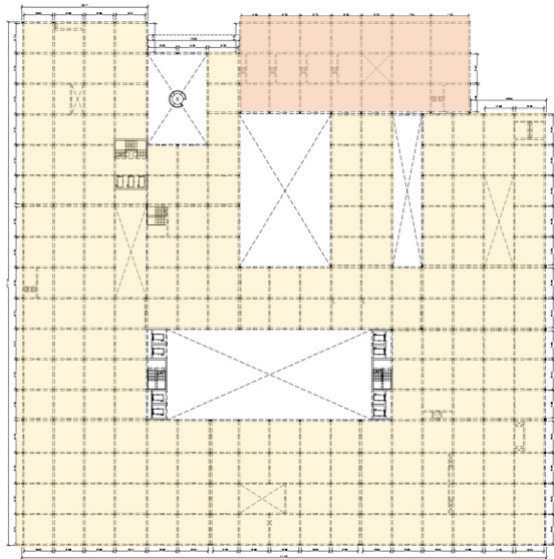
Predimensionamiento de Vigas. Fuente: Elaboración Propia
